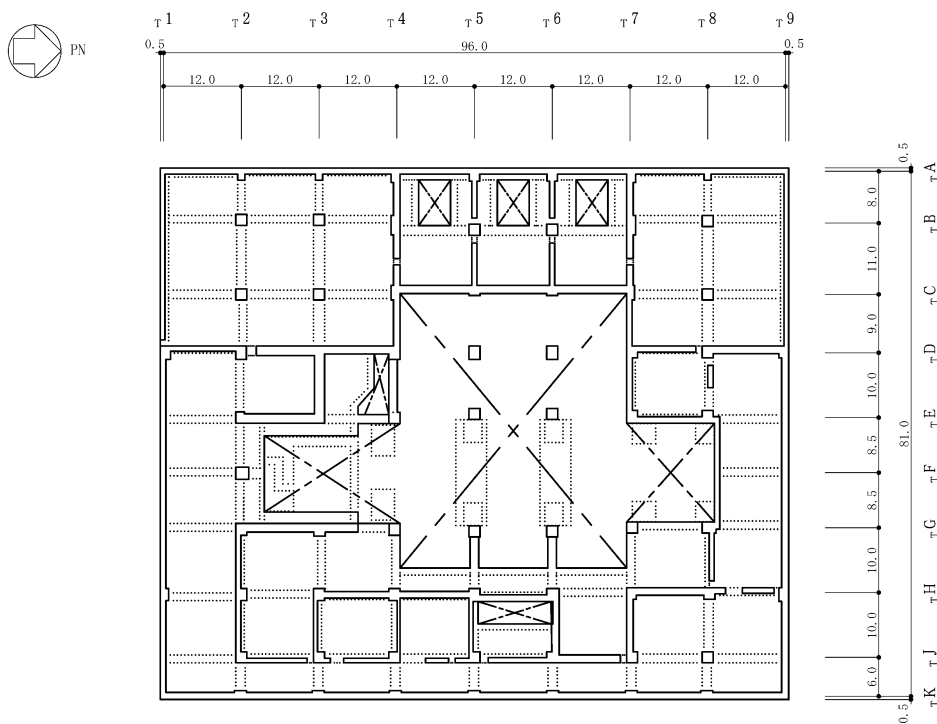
タービン建屋の概略平面図 (B1F, T.M.S.L. 4.9m) (2/6) (単位：m)
